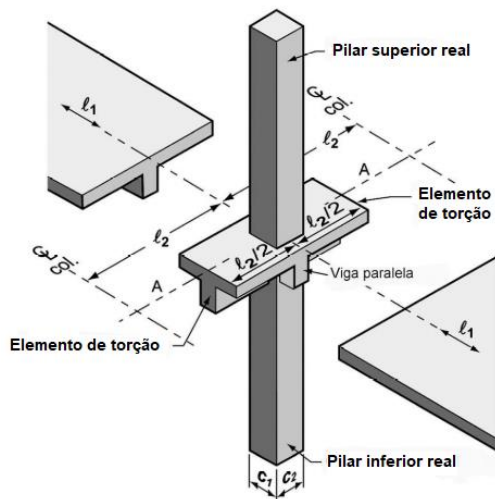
Pilar equivalente (ACI-318, 2014).
